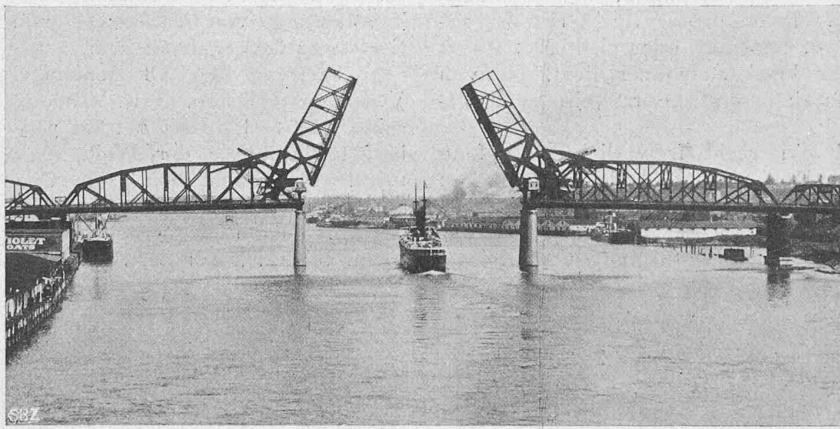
Broadway Bridge in Portland, mit geöffneter, 85 m weiter Durchfahrt.
